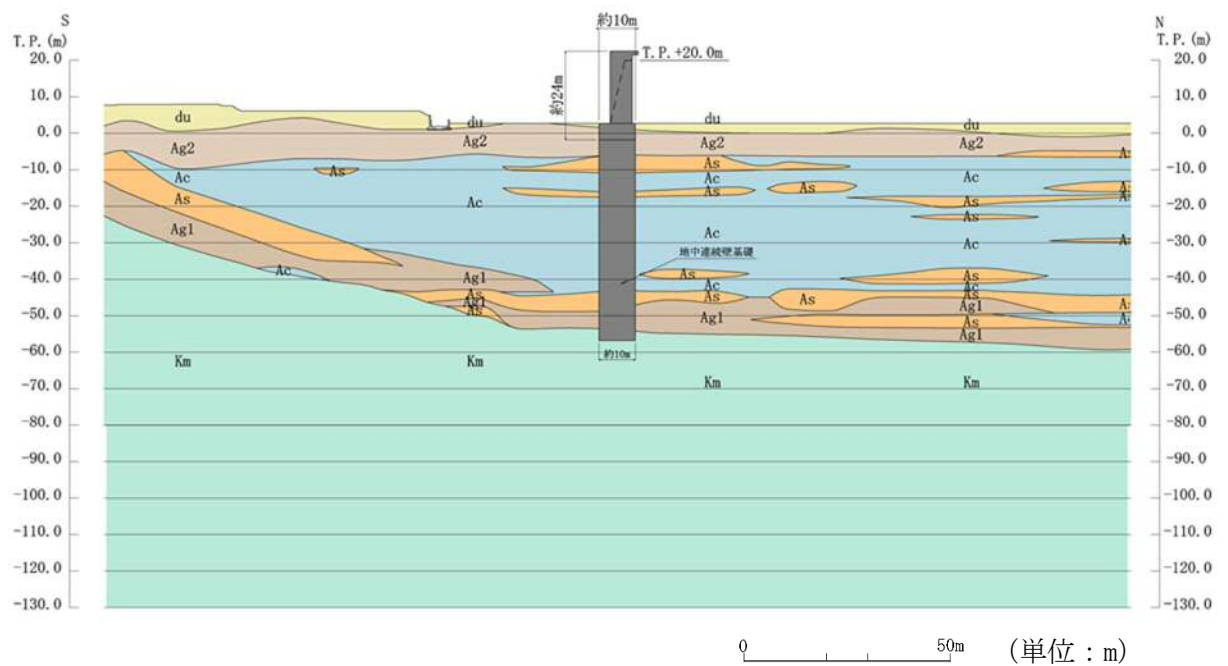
(1) 鉄筋コンクリート防潮壁 評価対象断面図 (①-①断面)
